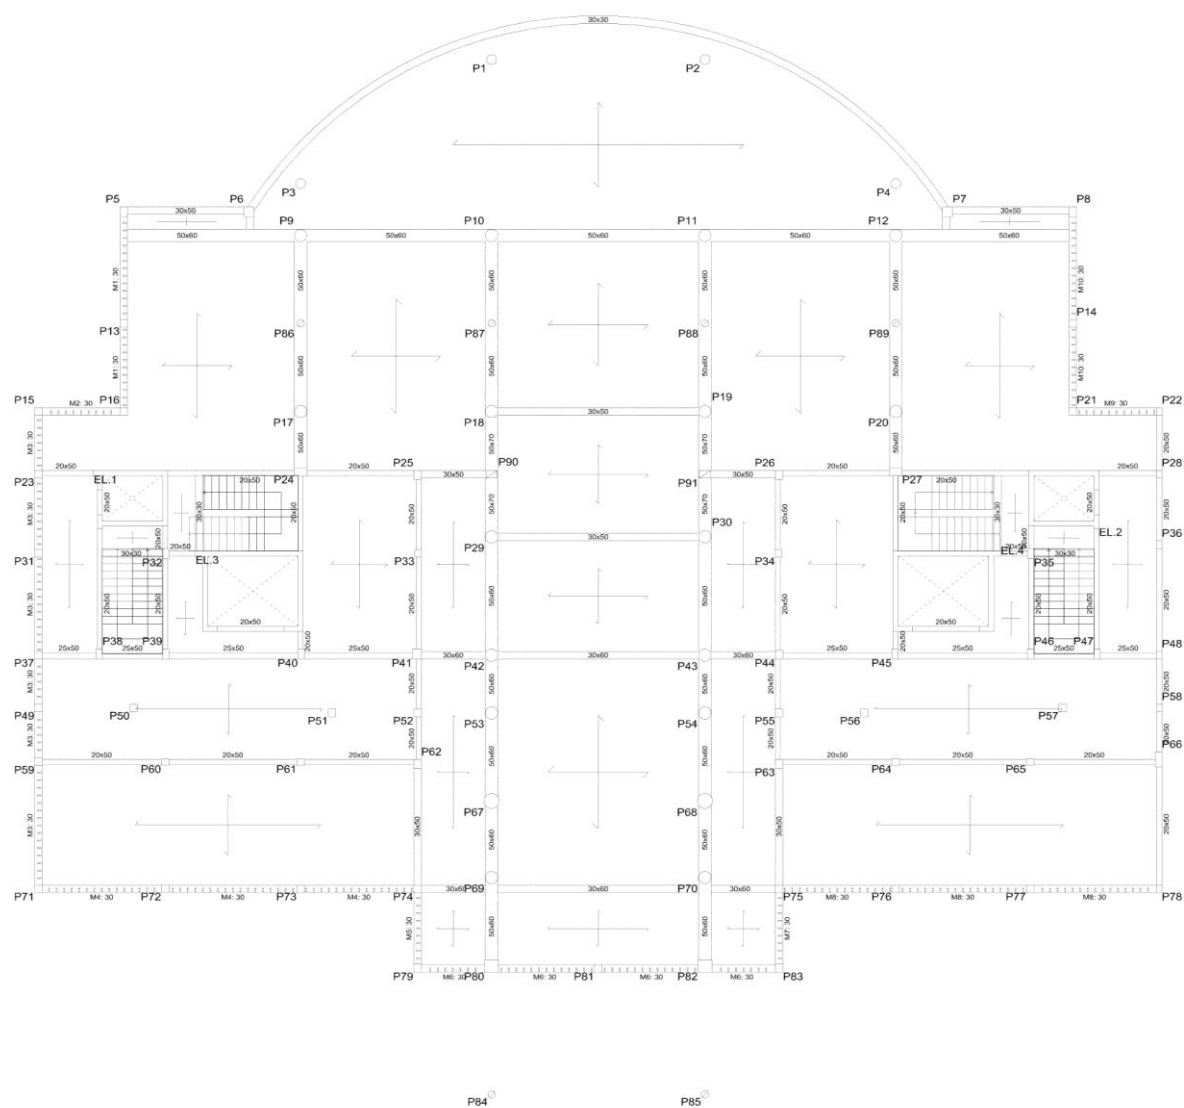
Planta estrutural do Rés-do-Chão: corpo E (s/escala).
